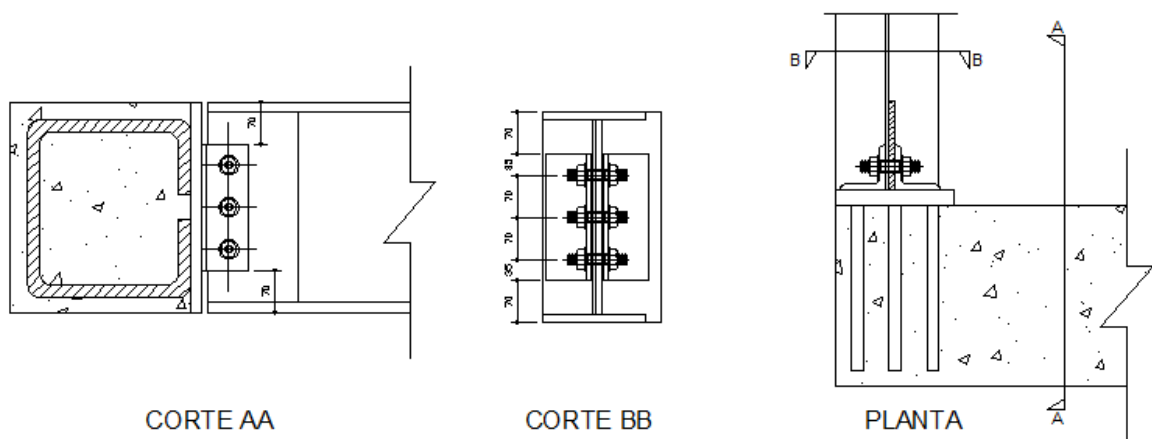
Detalhe da ligação da viga metálica da passarela com a viga de concreto do prédio (CEPLAN - UnB, 2009)
